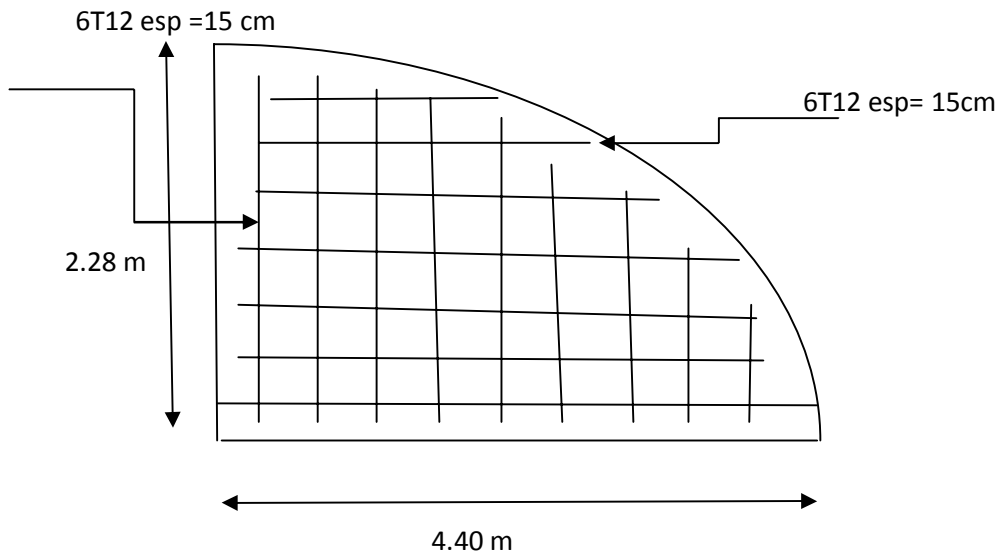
Dessin Ferrailage du panneau de la dalle pleine.
